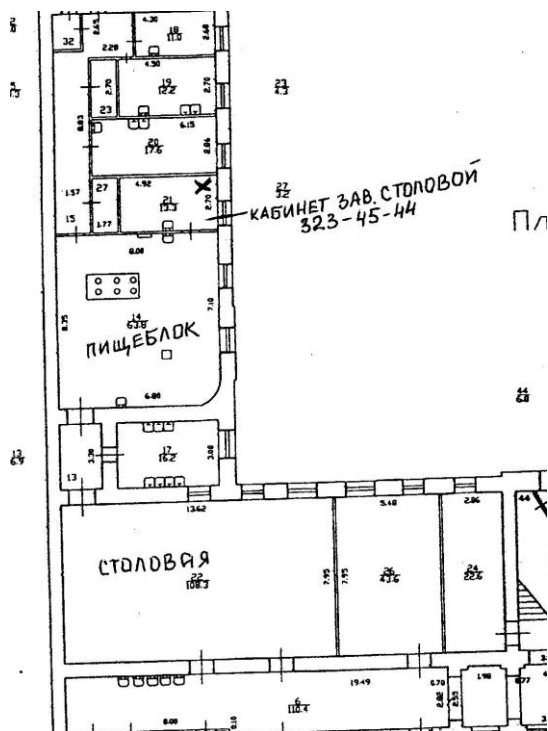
План помещений столовой ГБОУ гимназии № 24 им. И.А Крылова
